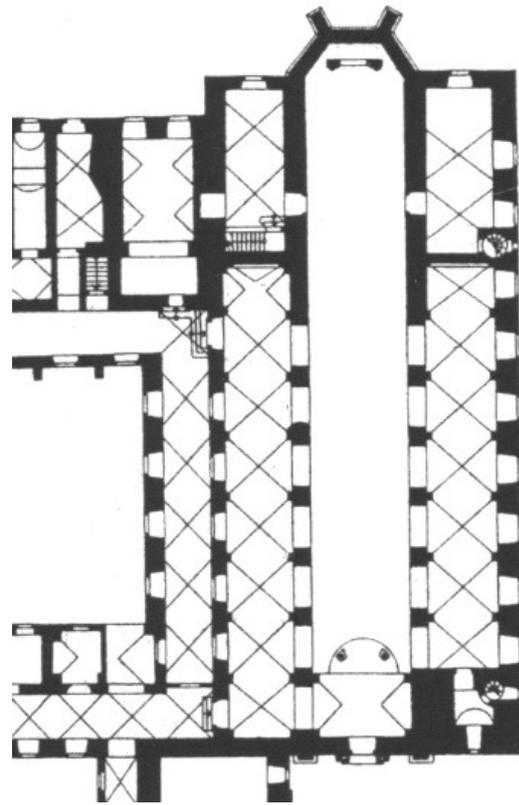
Geras, Stiftskirche, Grundriss heute.
